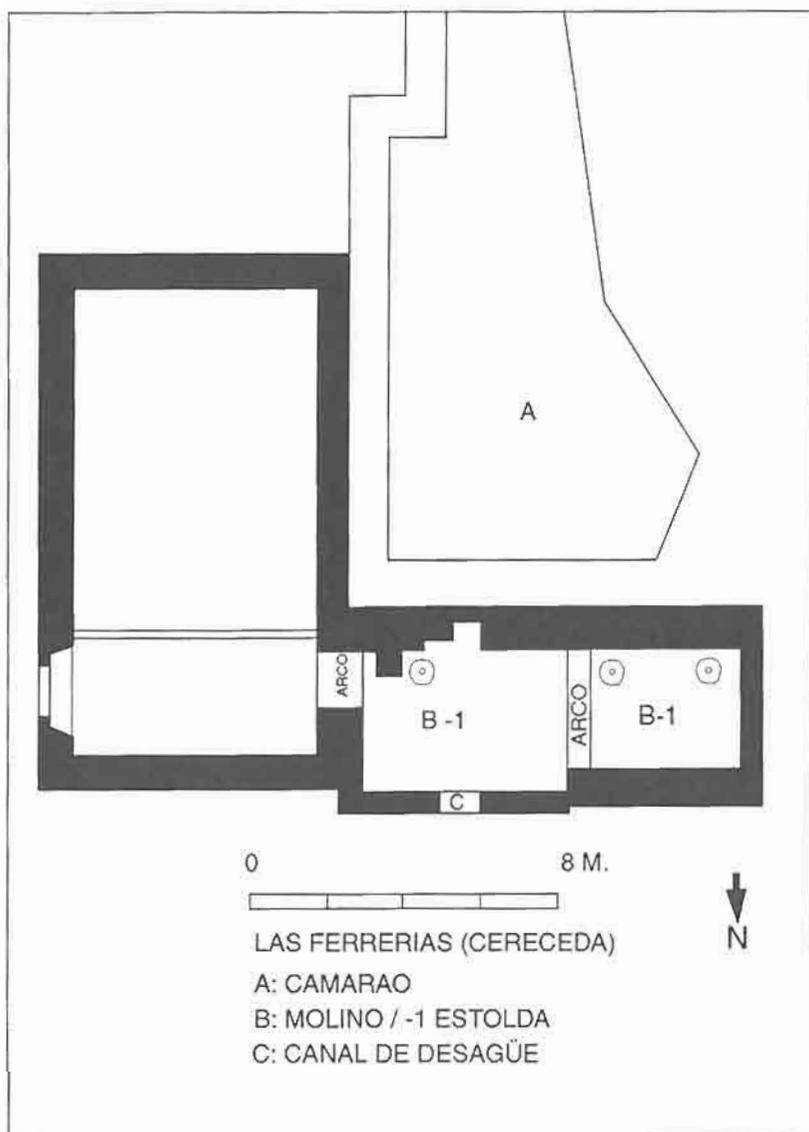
Planta de Las Ferrerías. (Cereceda)
